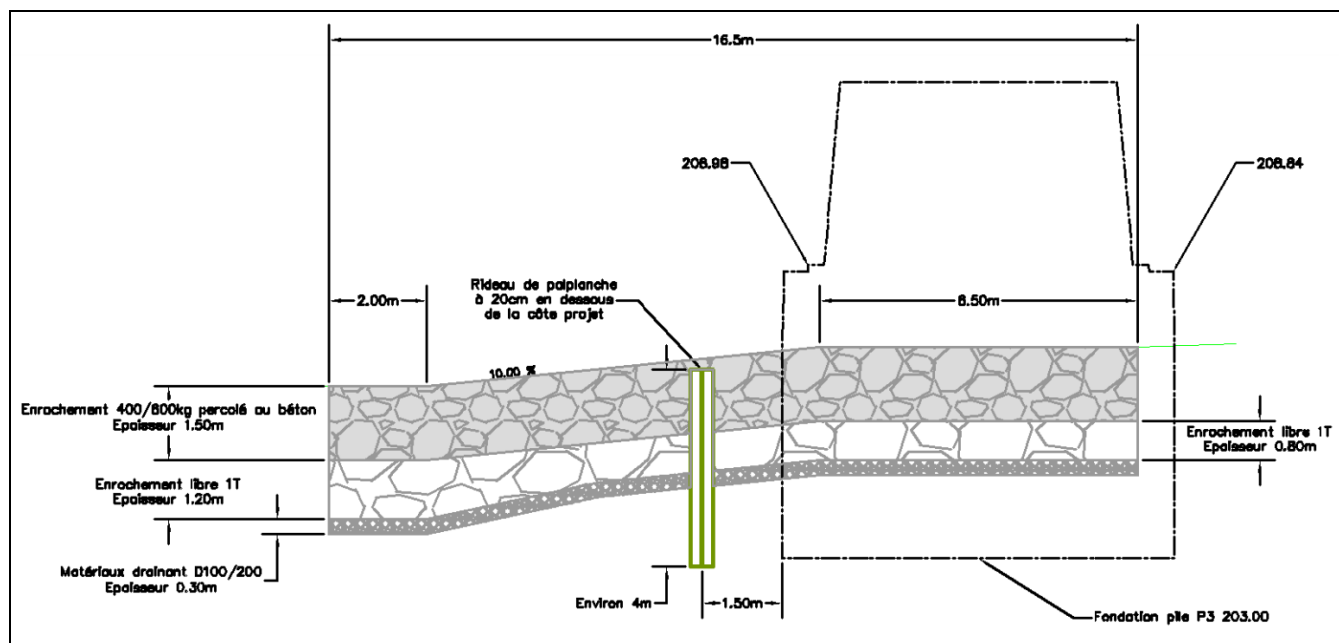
Vue en coupe longitudinale de la rampe à canoë
